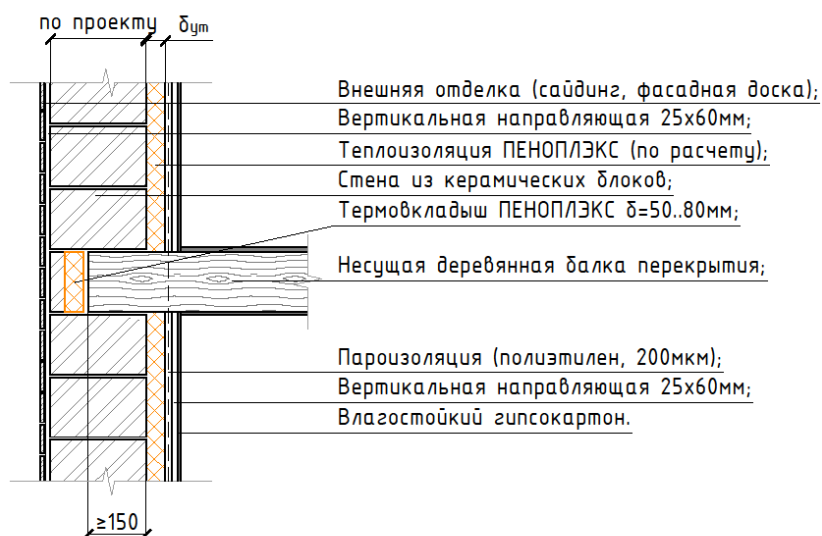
Схема сопряжения стены из облегченных блоков с деревянным перекрытием (плиты ПЕНОПЛЭКС изнутри).
